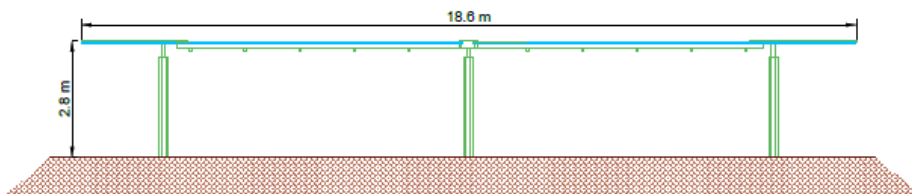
Progetto strutture – particolari di montaggio (allegato C_027_INT_T_27)
